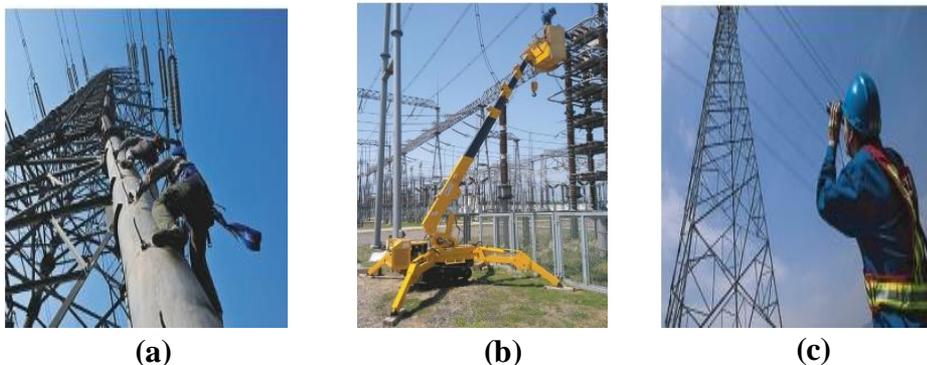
Méthodes d'inspection traditionnelles : (a) inspection par exploration en ligne ; (b) inspection au sol ; (c) inspection manuelle avec un télescope.[40]
